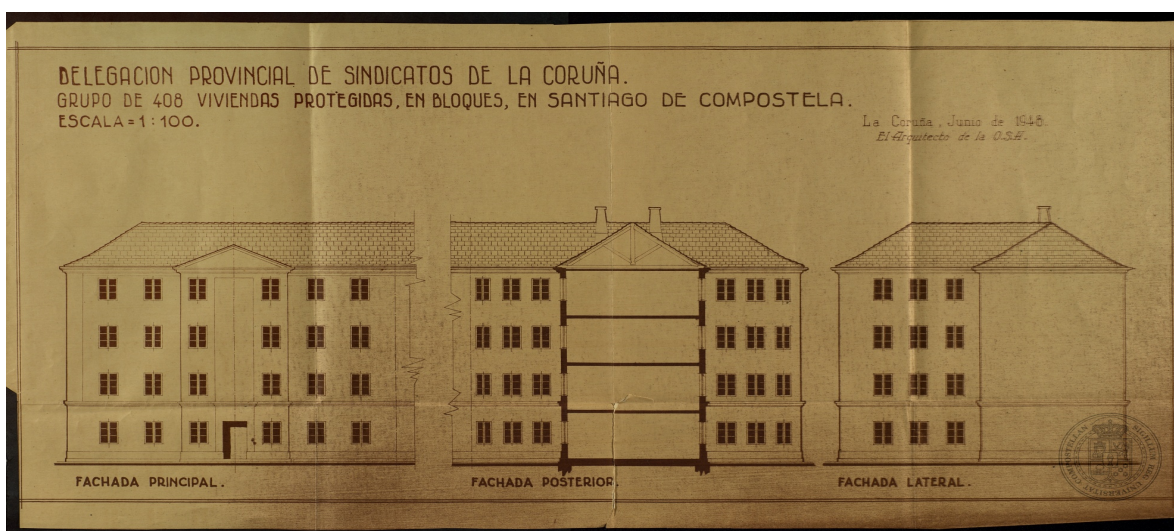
Proyecto de Grupo de Viviendas de la OSH para el “Monte de Conxo”,1948.
